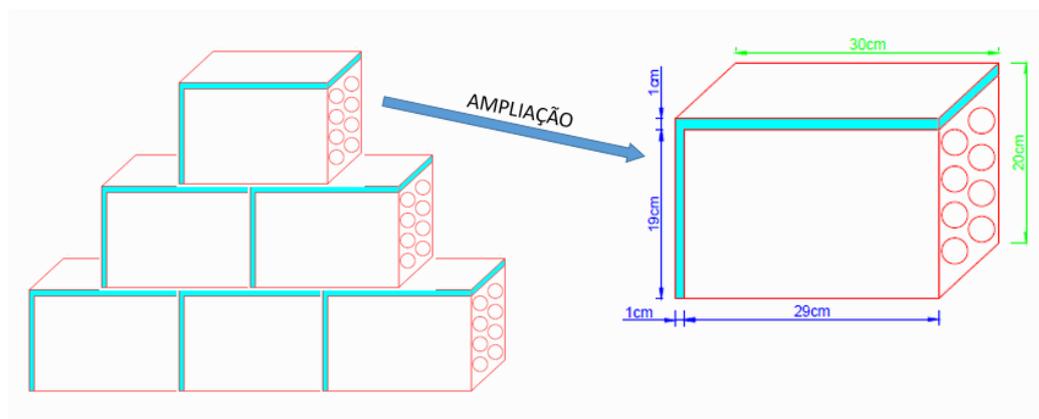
Tijolo assentado com massa de aproximadamente 1 cm de espessura para fixação de um tijolo com o outro tijolo.
